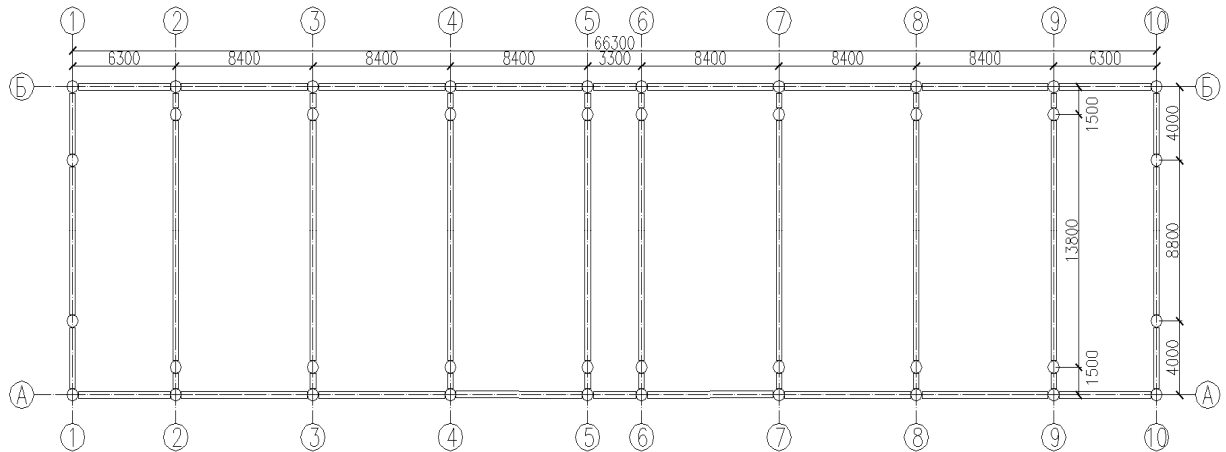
Схема расположения рам каркаса надстройки в плане здания / Fig. 2. Scheme the location of the superstructure frame in the plan building
